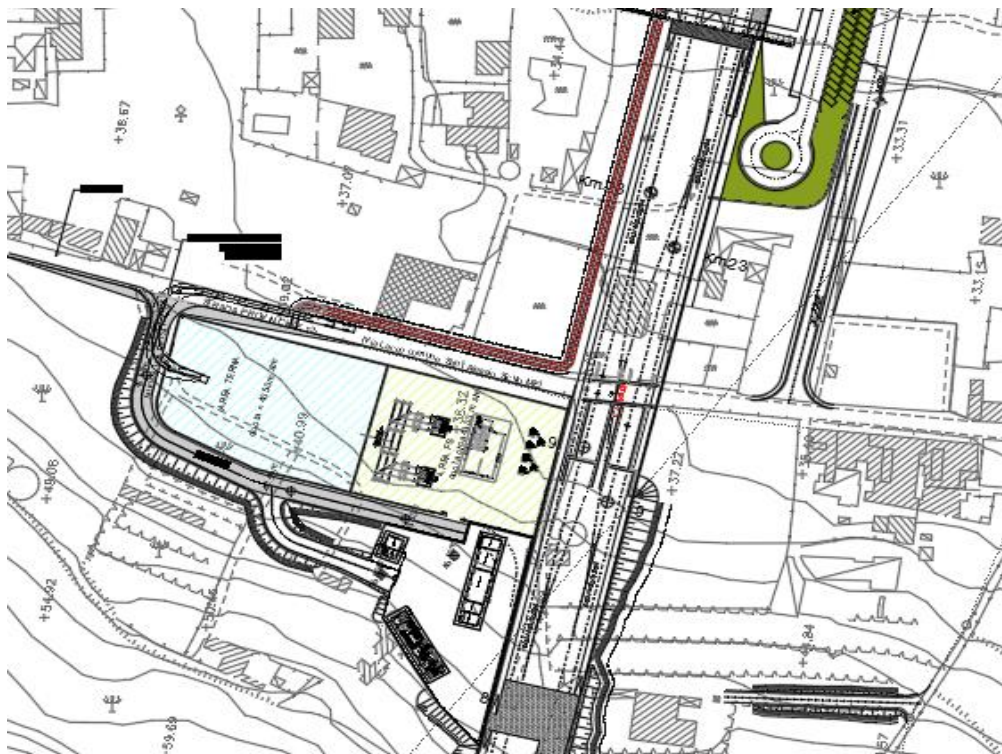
Stralcio planimetria SSE Sant'Alessio Siculo (MS)
